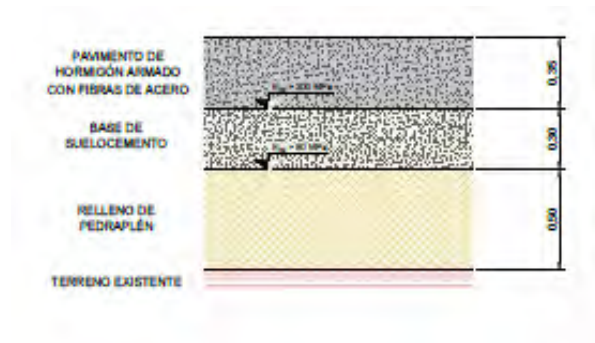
Propuesta de firmes de pavimento de hormigón armado con fibras metálicas para la nueva terminal de contenedores.
